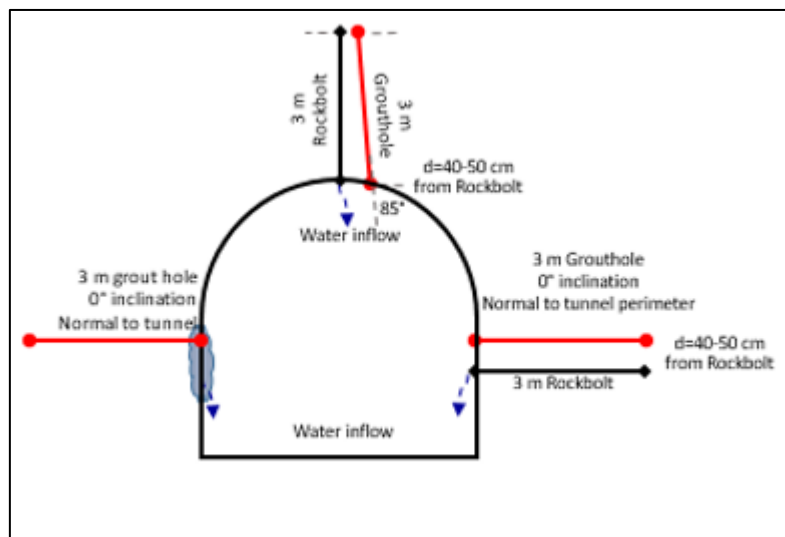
Ejemplo de patrón de diseño de spot-grouting complementario para Drill & Blast.
